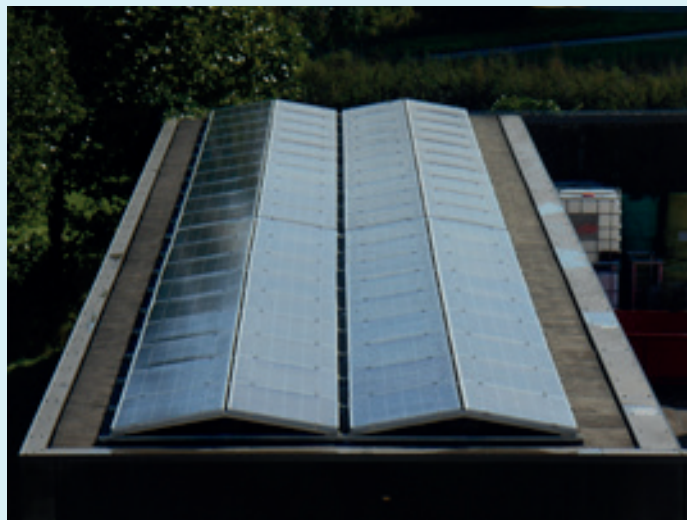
De zonnepanelen zijn aangebracht tot de dakranden. Hoe onderhoud te plegen?
